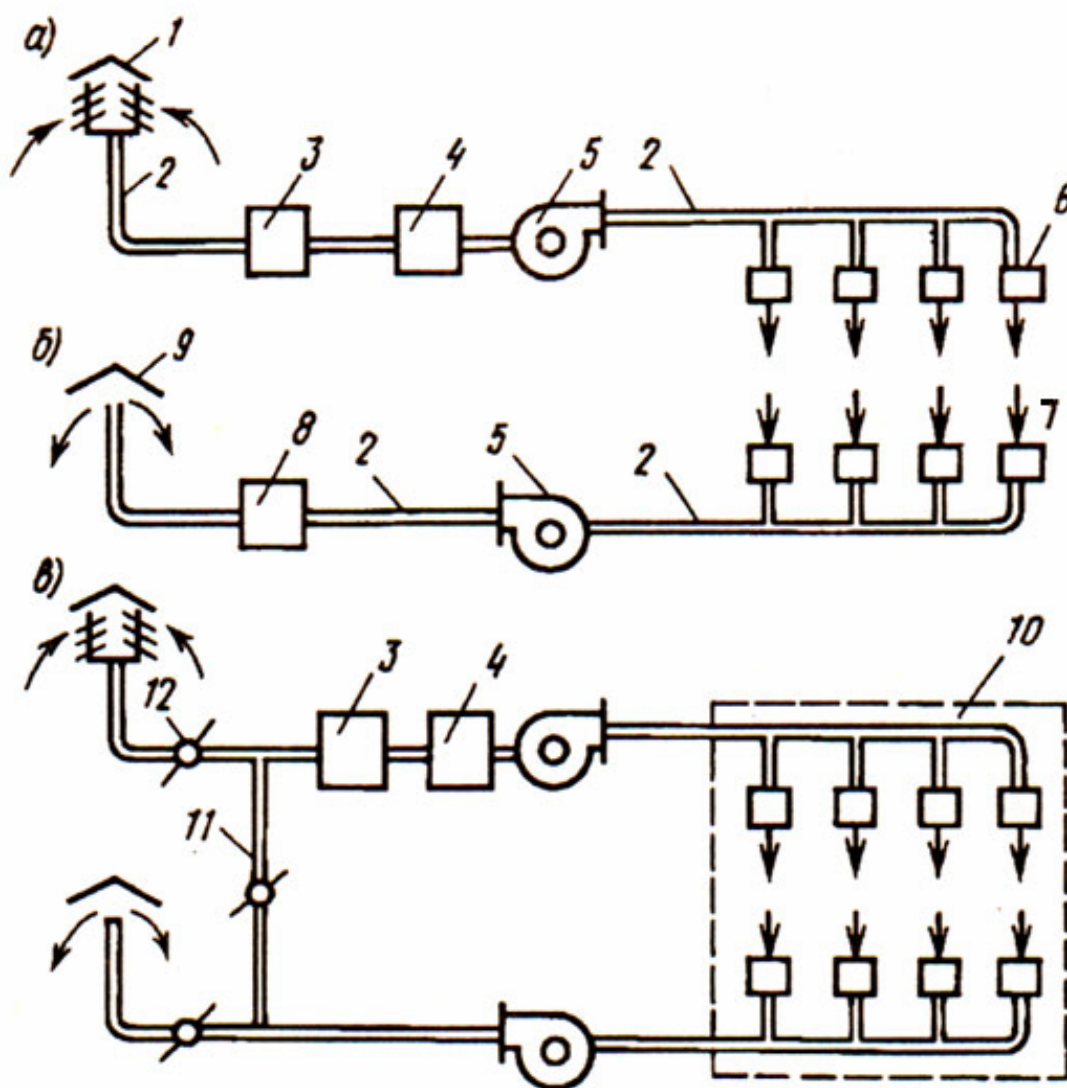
Системы вентиляции: а – приточная; б – вытяжная; в – приточно-вытяжная; 1 – воздухоприемник; 2 – воздуховоды; 3 – фильтр; 4 – калорифер; 5 – вентилятор; 6 – воздуховыпускные насадки; 7 – вытяжные насадки; 8 – очистное устройство; 9 – вытяжная шахта; 10 – помещение; 11 – воздуховод; 12 – клапаны
